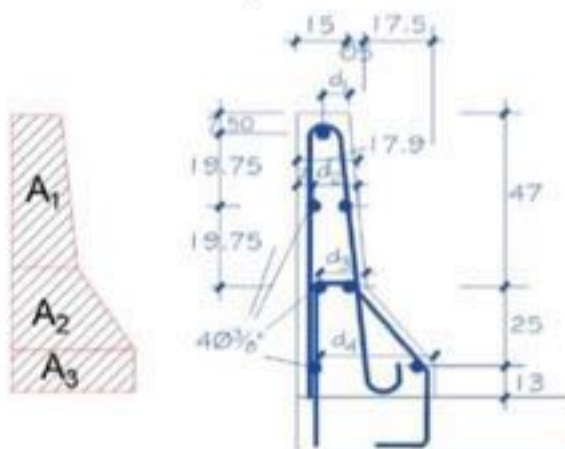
División en secciones de la barrera tipo New Jersey y peraltes para el cálculo.
